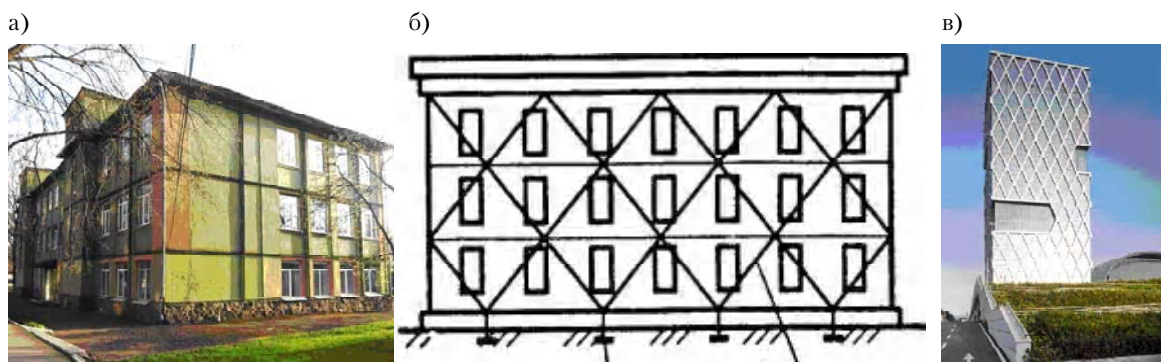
Примеры композиционно-художественного осмысления наружной конструктивной сетчатой системы в архитектурных решениях: а) укрепление металлическими бандажами конструкции здания школы в г. Макеевке; б) одна из схем конструктивного усиления стен здания; в) общий вид 19-этажного здания отеля Karok Shenzhen Bay в г. Шэньчжэн (Китай, 2014, архитектурное бюро Goettsch Partners).
